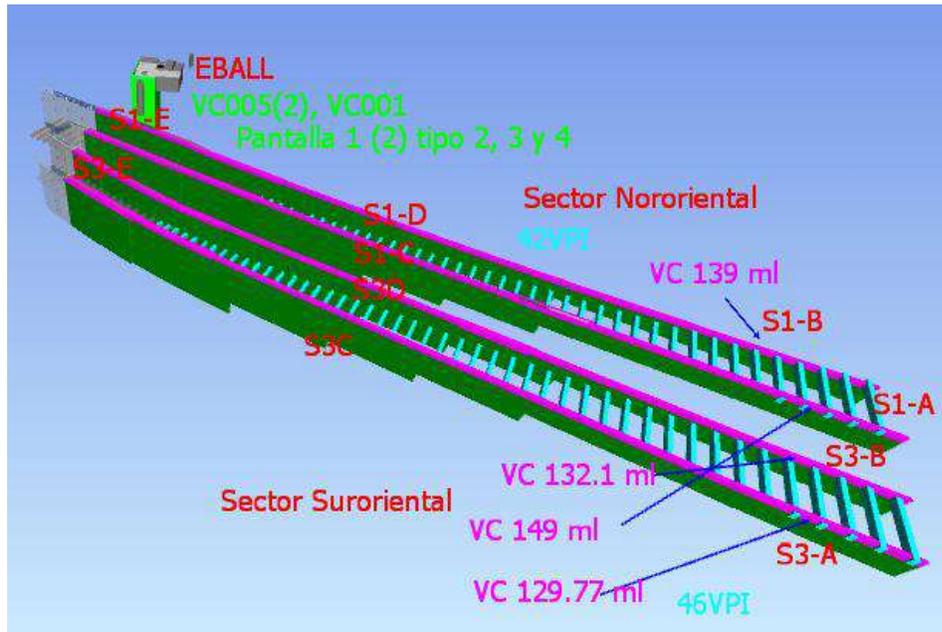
Esquema 3D muros, vigas puntales y vigas cabezales ejecutados costado oriental
